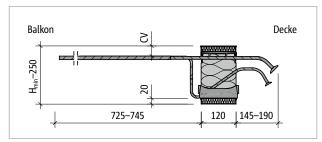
Schöck Isokorb® XT Typ K-O-M2: Produktschnitt
